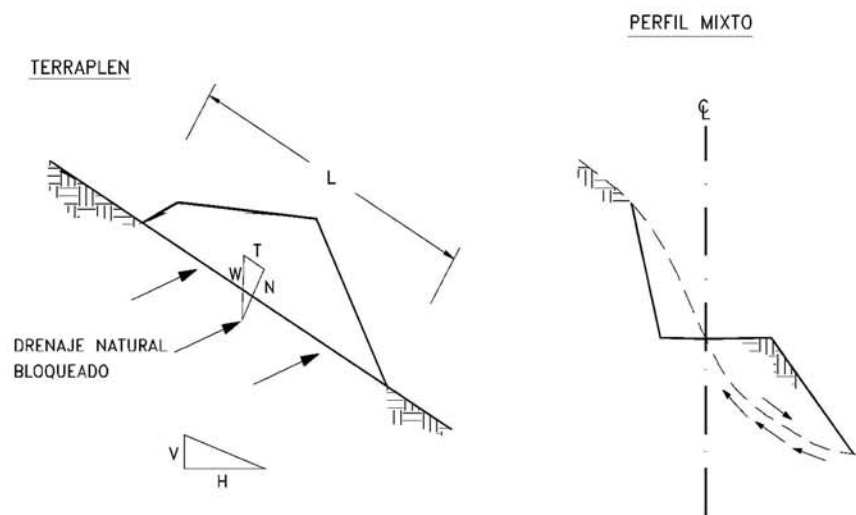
FIGURA b) CONSTRUCCION DE TERRAPLENES EN LADERAS
